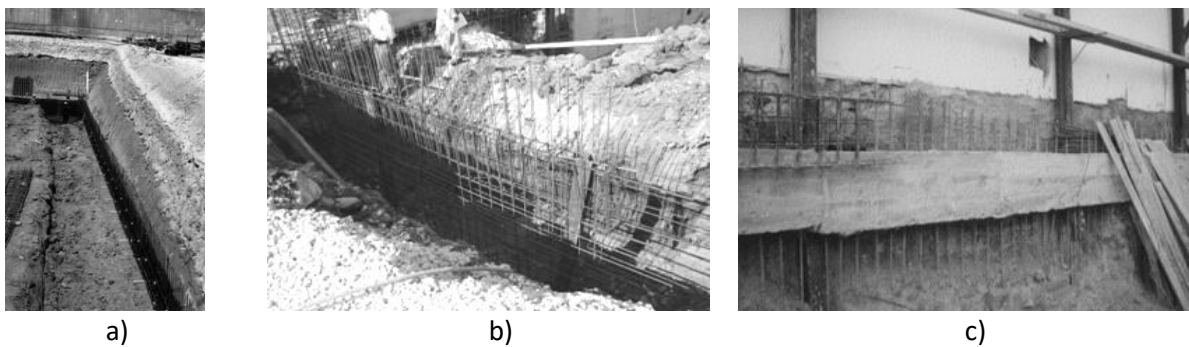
Etapas para a execução da viga de coroamento [64]
